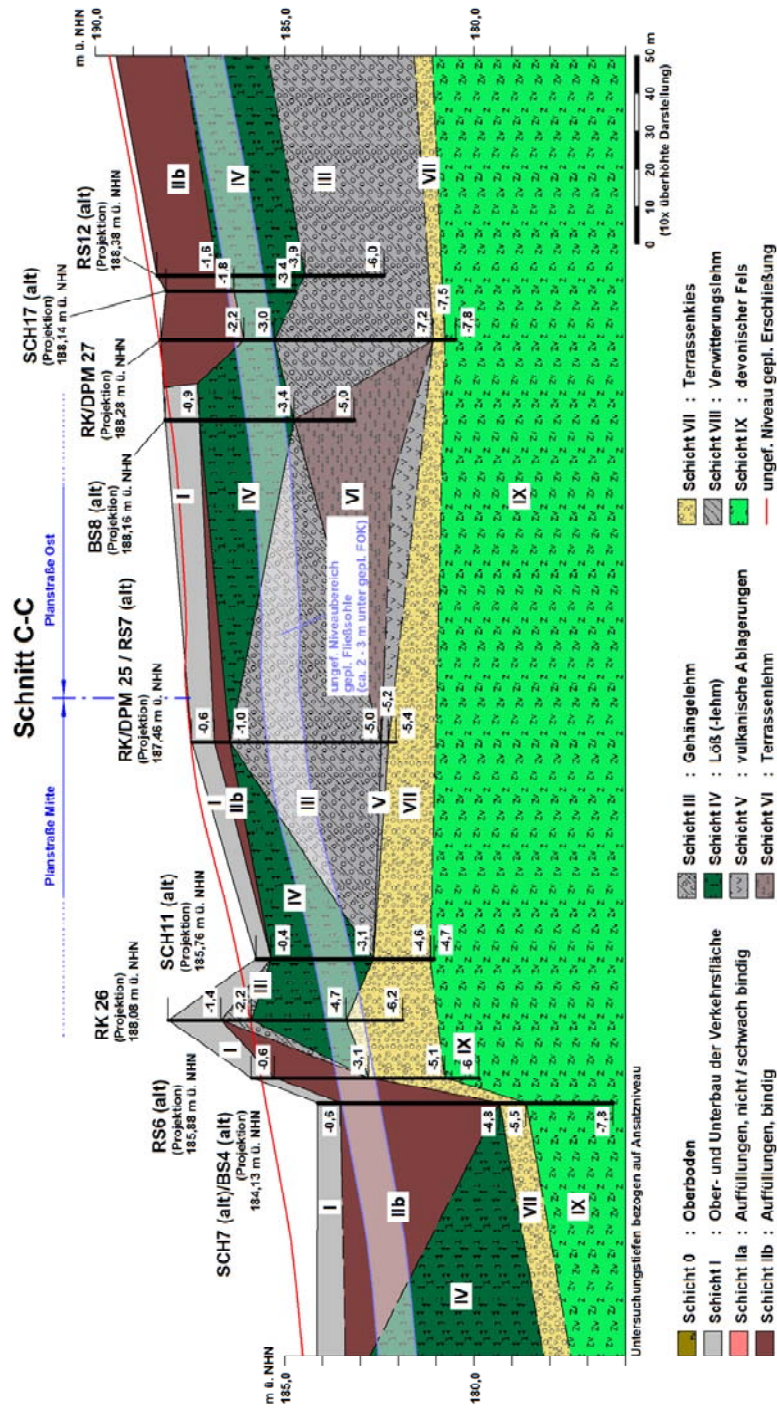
Baugrundmodell mit Schnitt C-C (Lage des Schnittes in Anlage 1)
